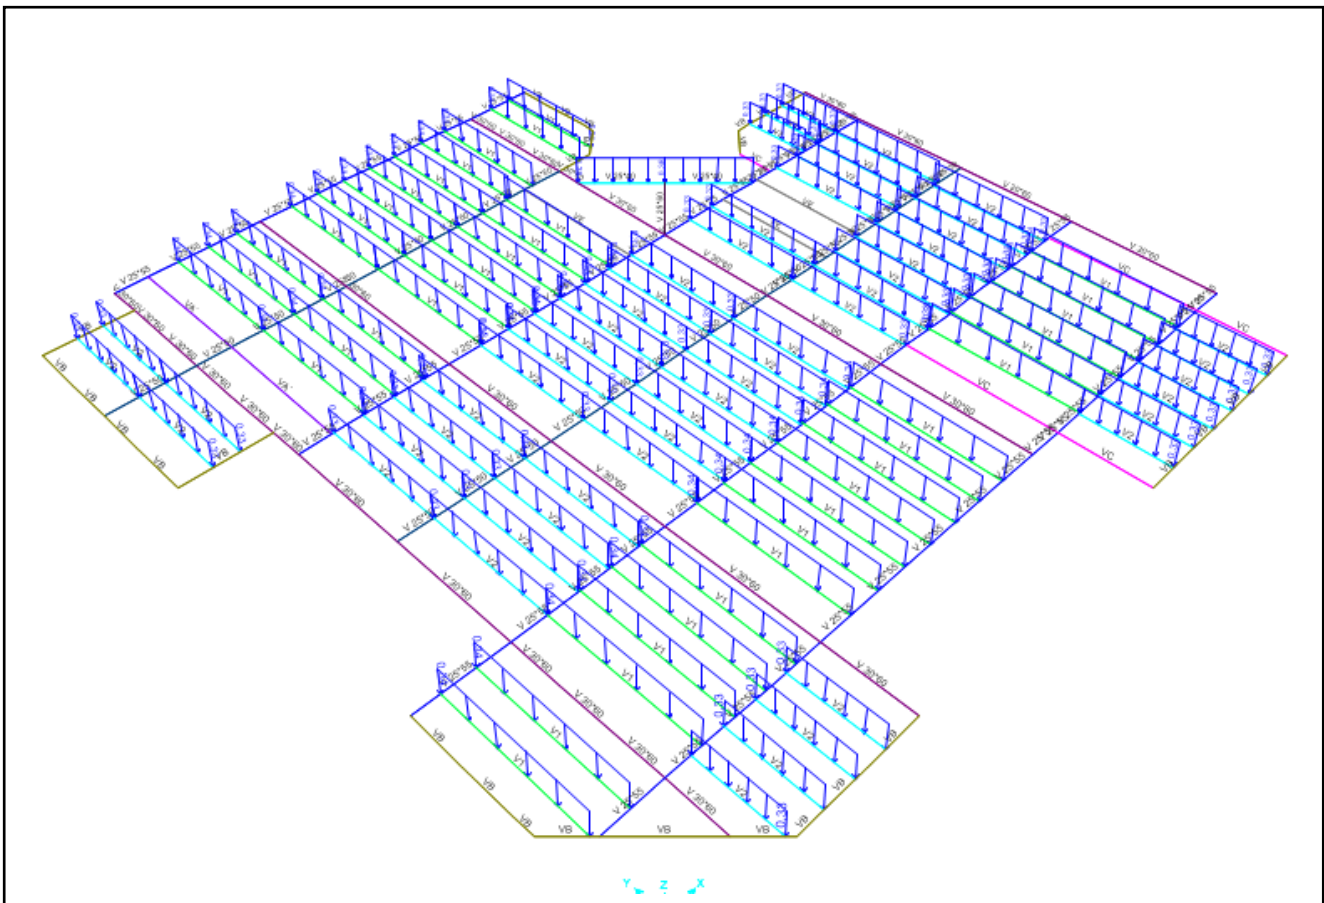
Vista en planta cuando se han aplicado las cargas de servicio.
